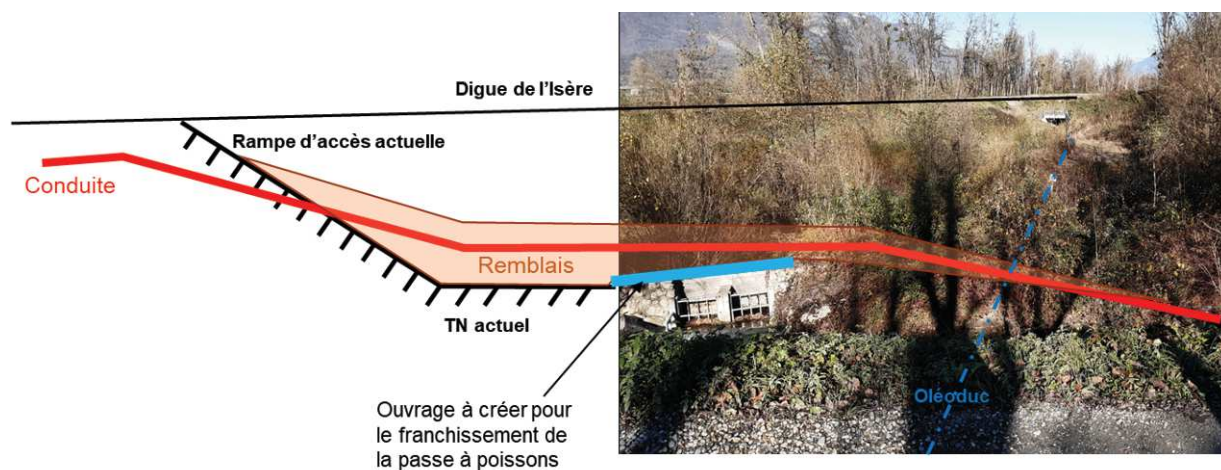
Schéma de principe du franchissement de la passe à poisson (vu depuis le chemin sur la rive gauche du Fay avec l'Isère sur la gauche)
